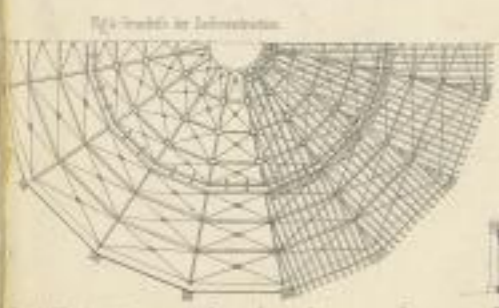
Plan der Lokomotivschuppen mit dem zentralen Einbaubau
